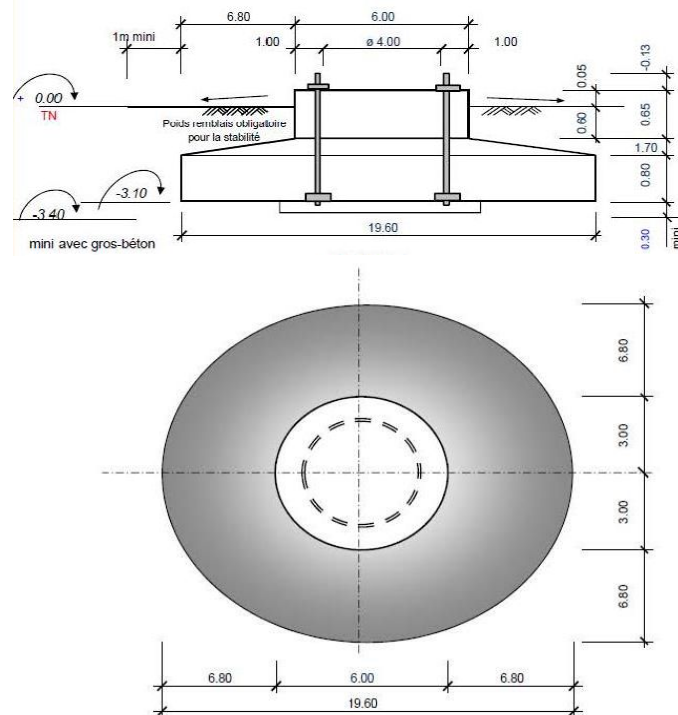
Différentes vues sur les fondations (source : Vestas, 2017)
